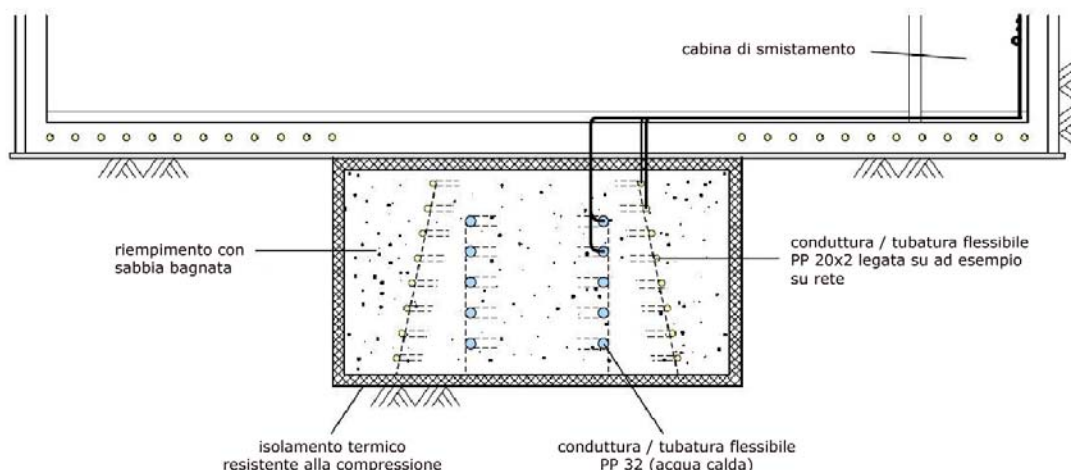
serbatoio interrato sotto la platea di fondazione
